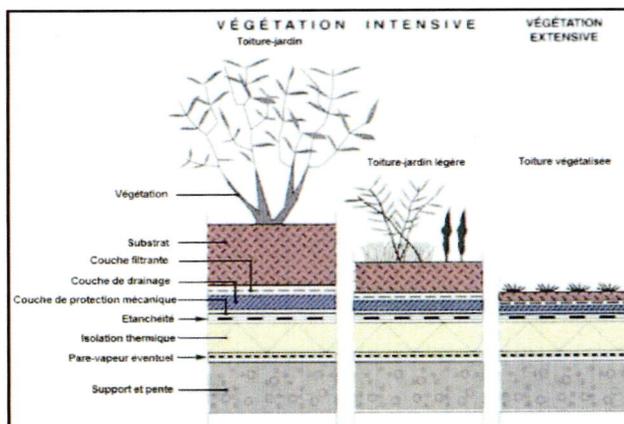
Détail 1 (Coupe d'une toiture végétalisée).
